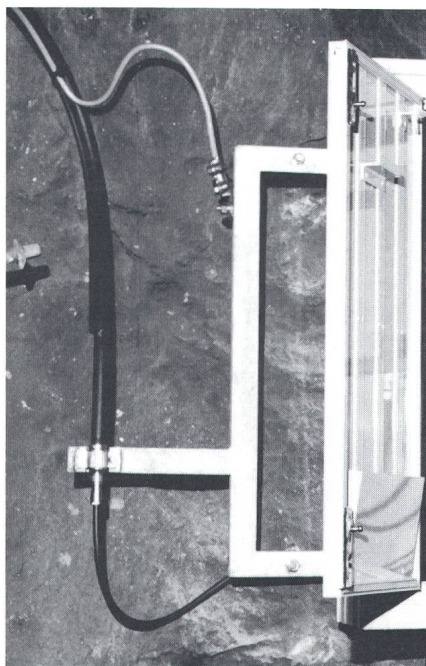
Prinzipaufbau einer Tunnelfunkanlage
